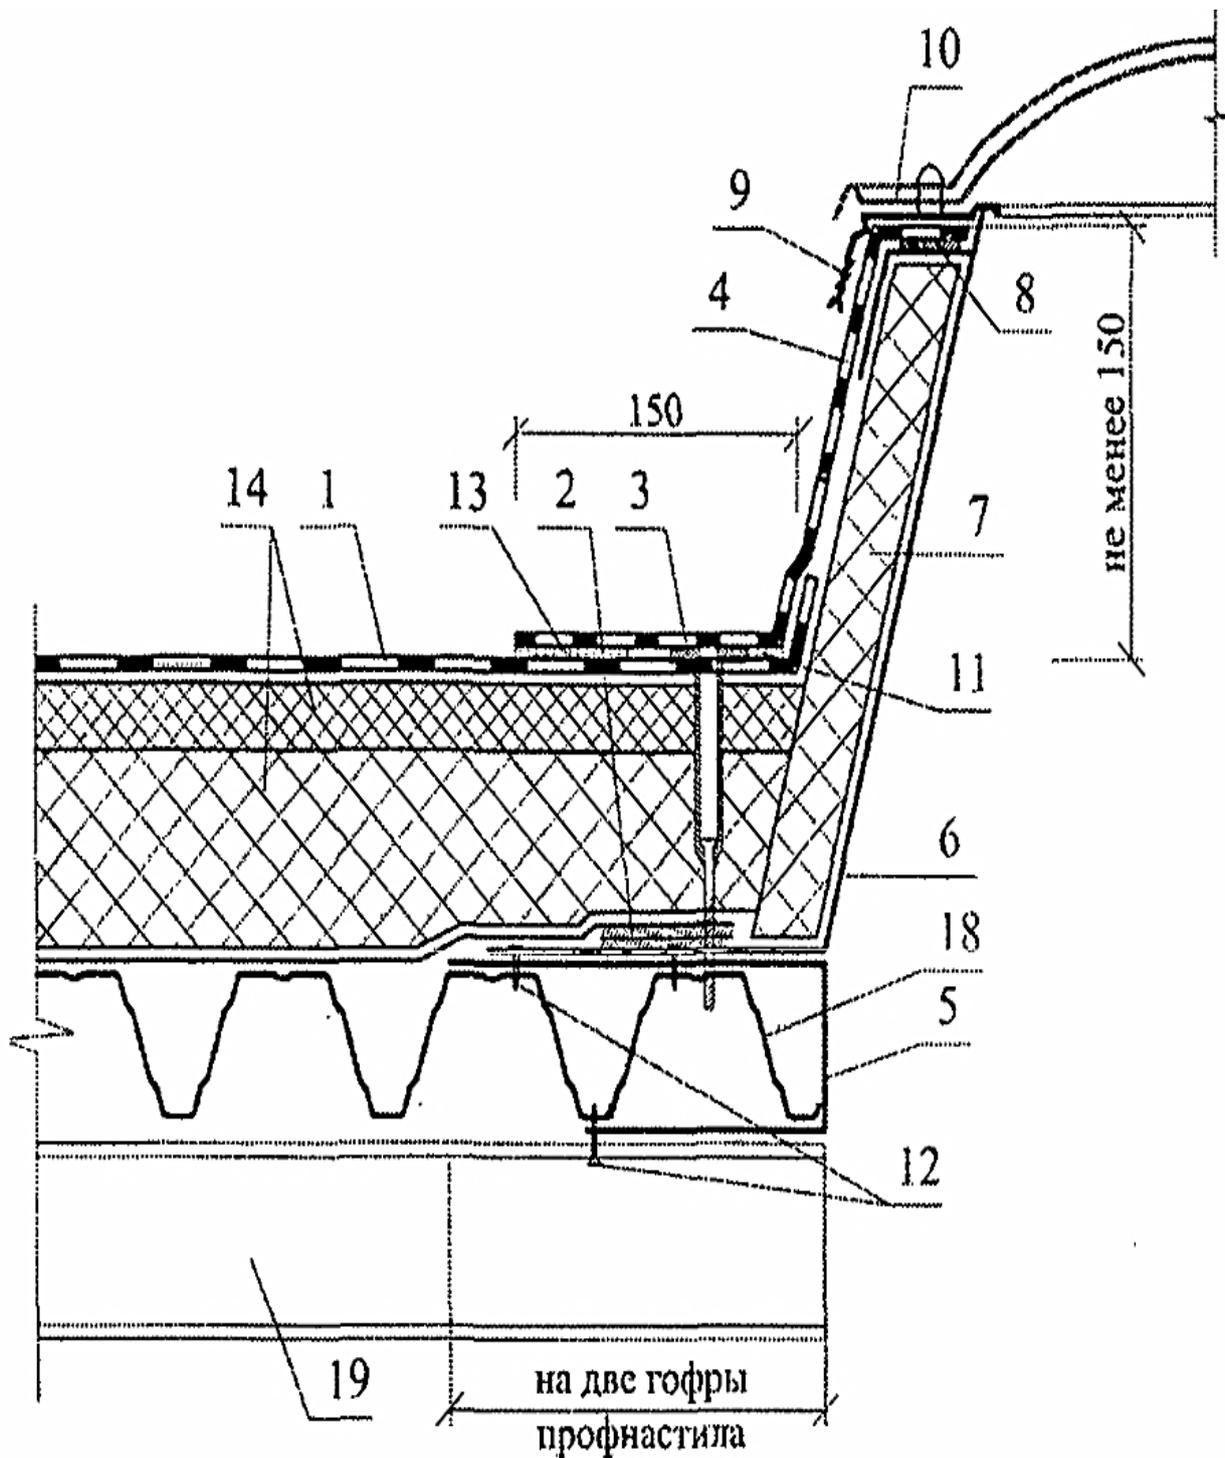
Примыкание двухслойной кровли с механическим креплением фартука к поверхности стены при сплошной наклейке водоизоляционного ковра
